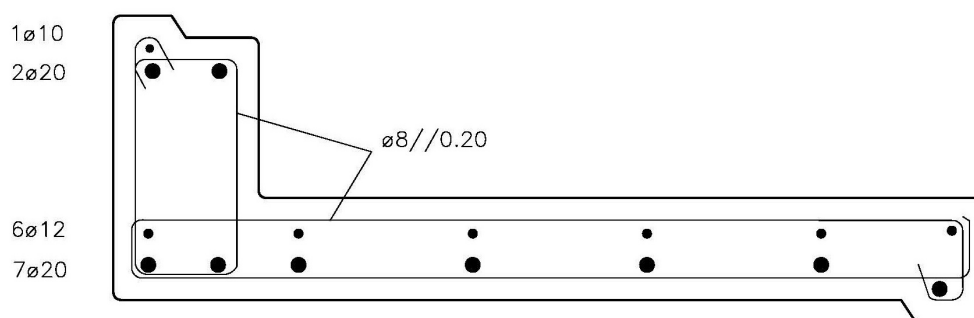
Corte Transversal de uma Viga de Bancada Pré-Fabricada
